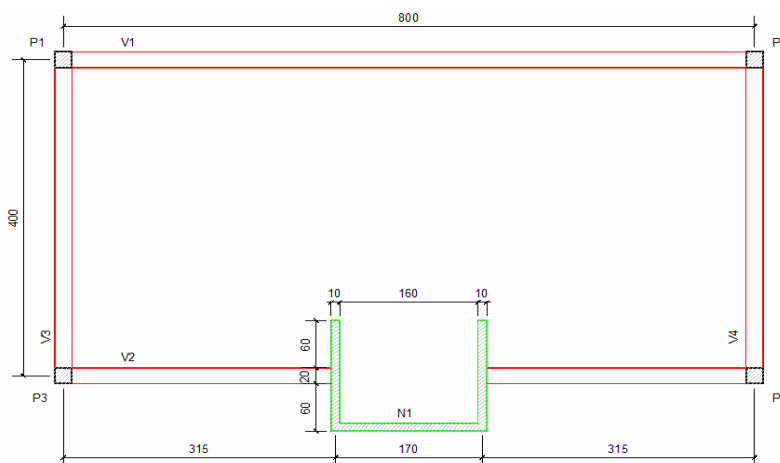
Pórtico enrijecido em planta (dimensões em cm)
